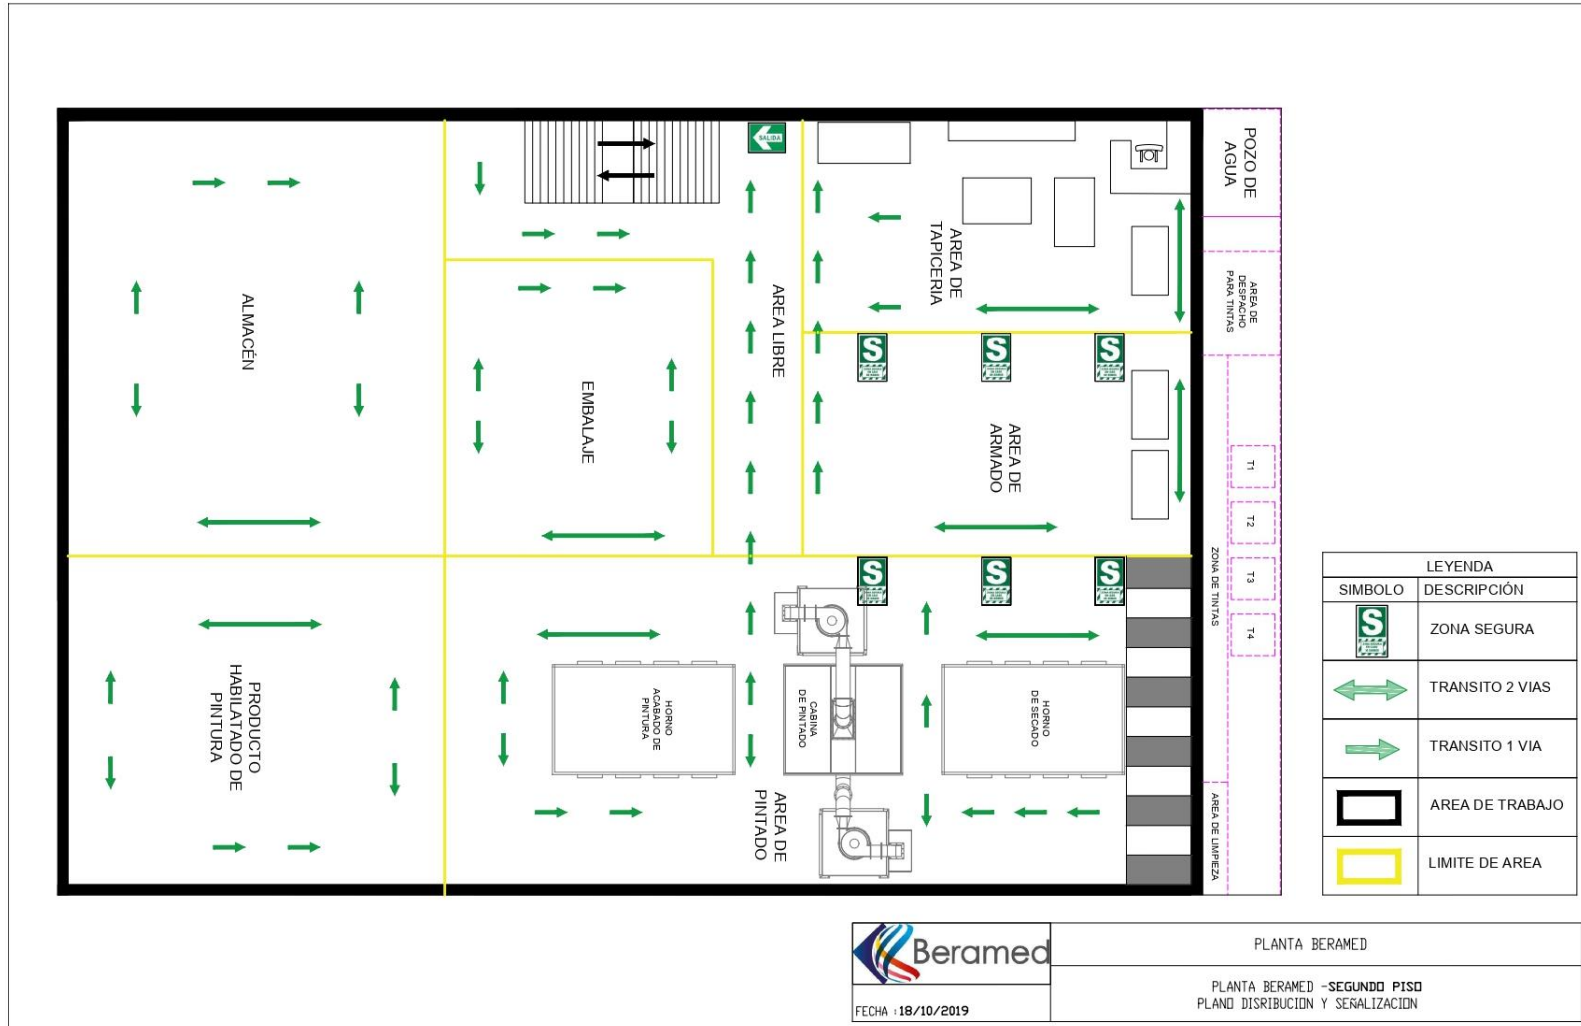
Layout de planta – segundo piso en Beramed EIRL
